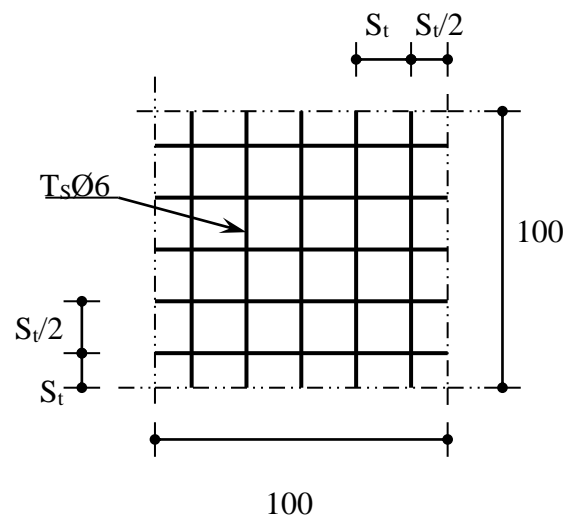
Disposition constructive des armatures de la dalle de compression
